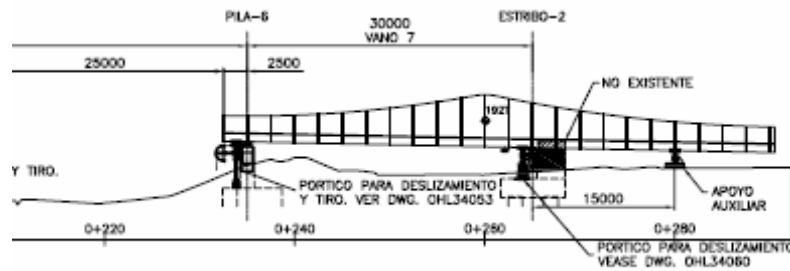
Tramo de la estructura Eje 1 lanzado desde Pila 6
